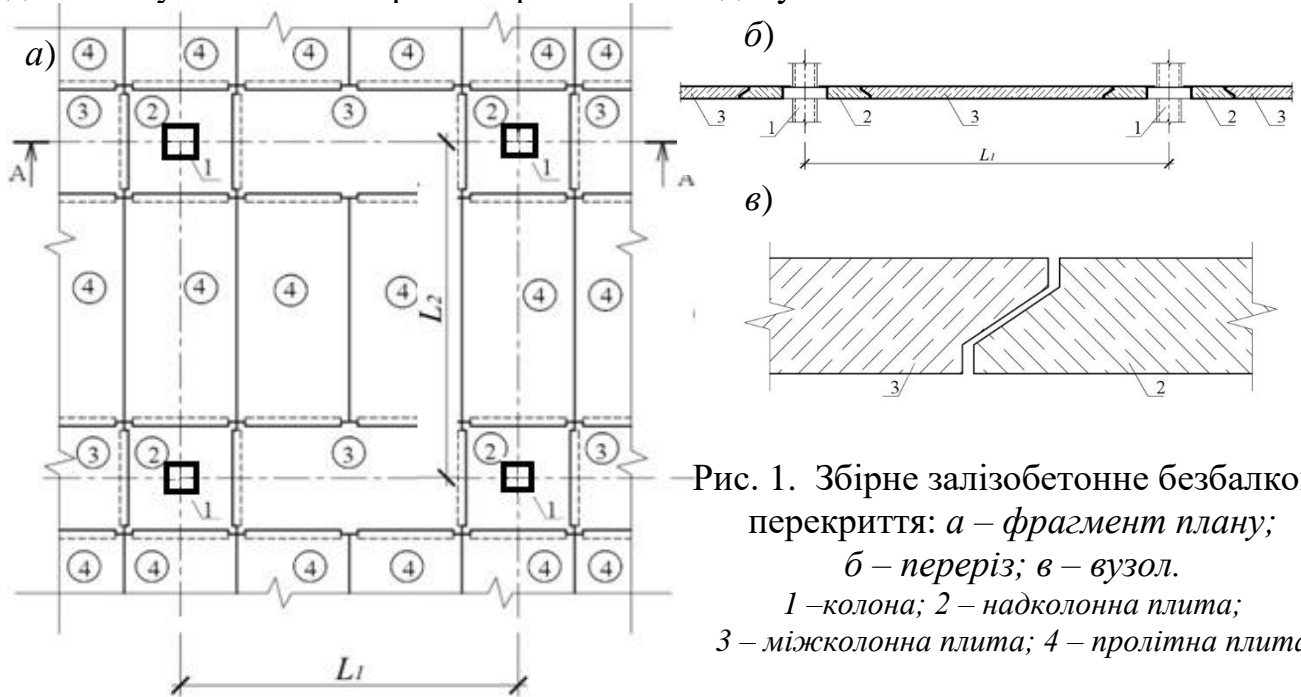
Збірне залізобетонне безбалкове перекриття: а – фрагмент плану; б – переріз; в – вузол.
